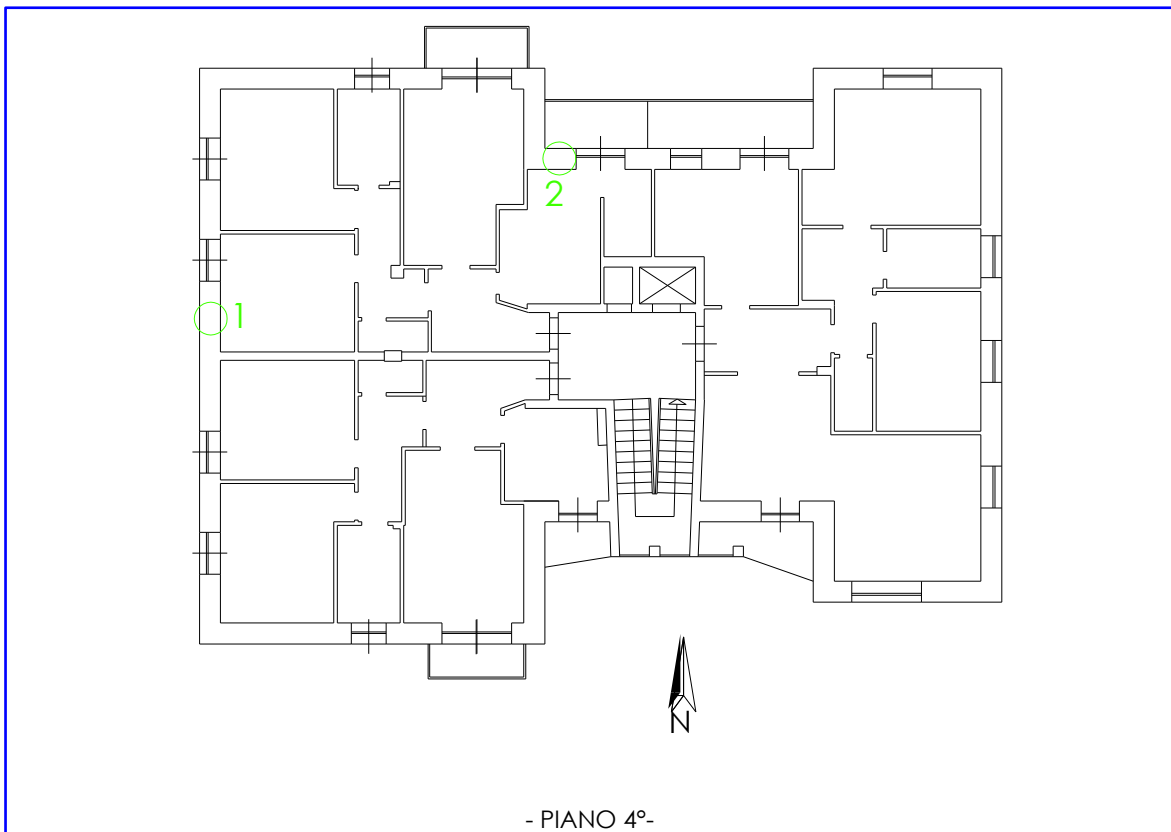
Planimetria del piano quarto (L4) con l'ubicazione delle zone esaminate
